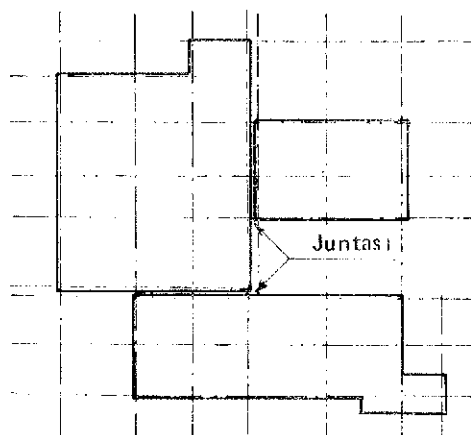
Esquema de la planta de un edificio con las juntas recomendables.
